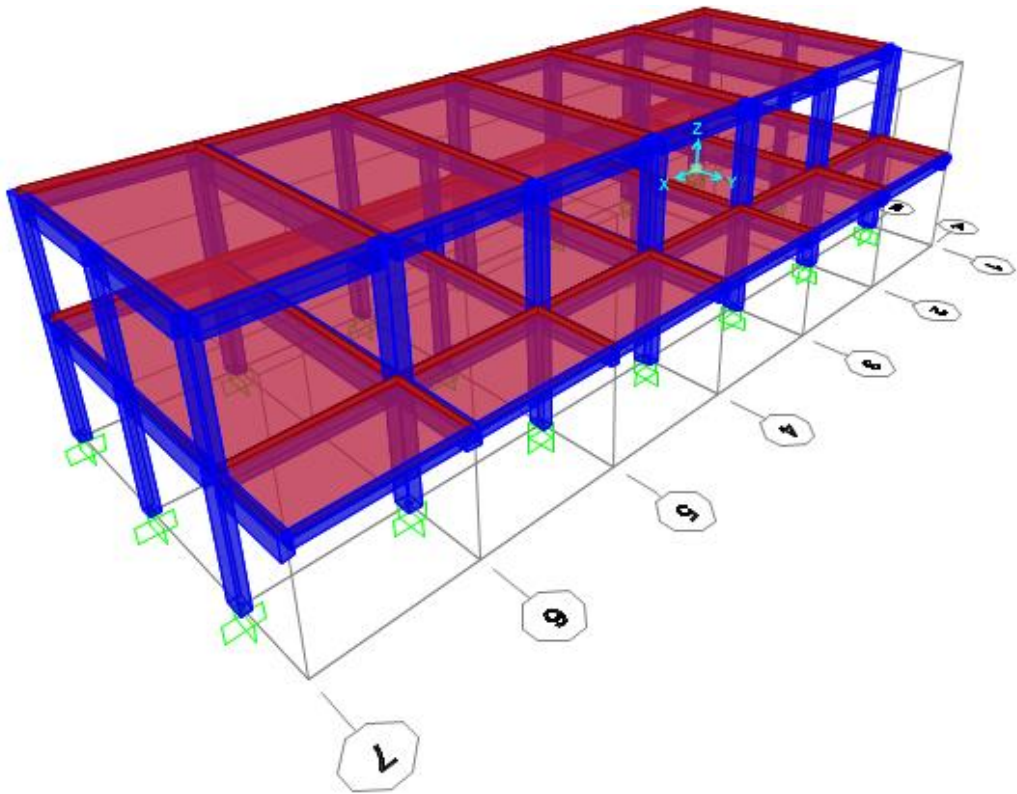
Idealización de la estructura. Fuente: Elaboración propia.
